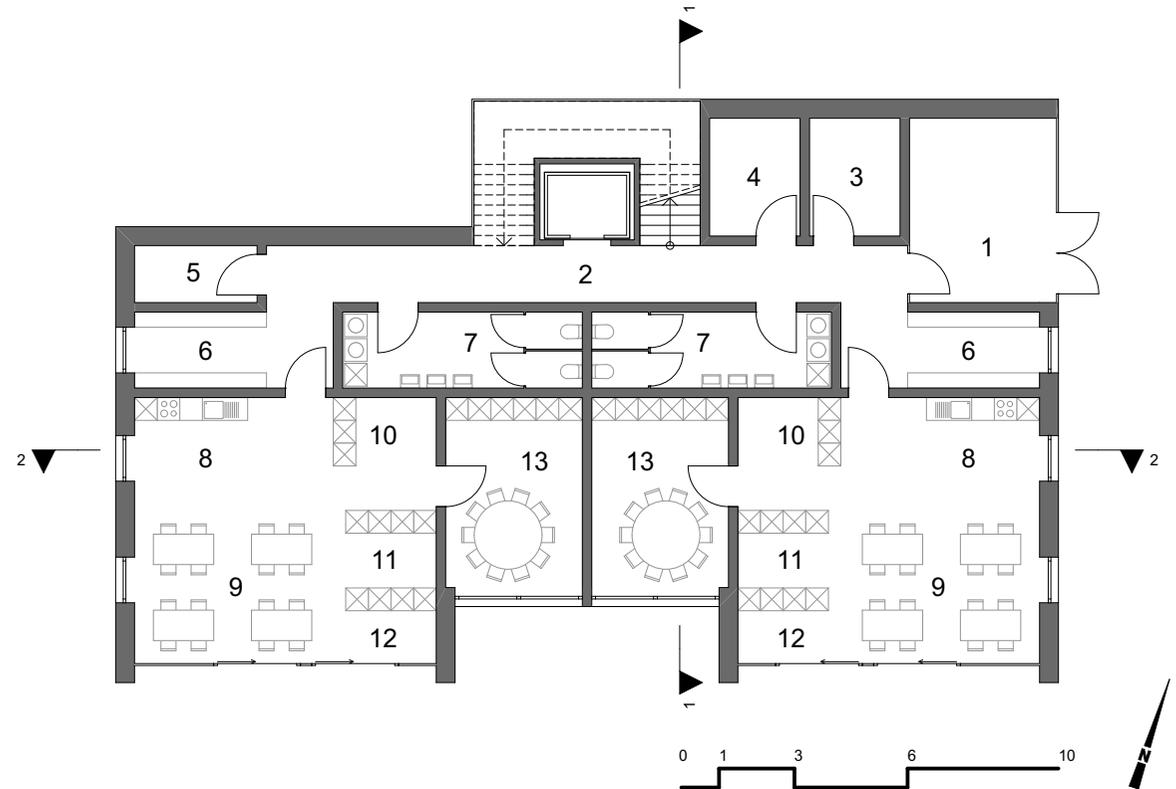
Grundriss Erdgeschoss Kindergarten
